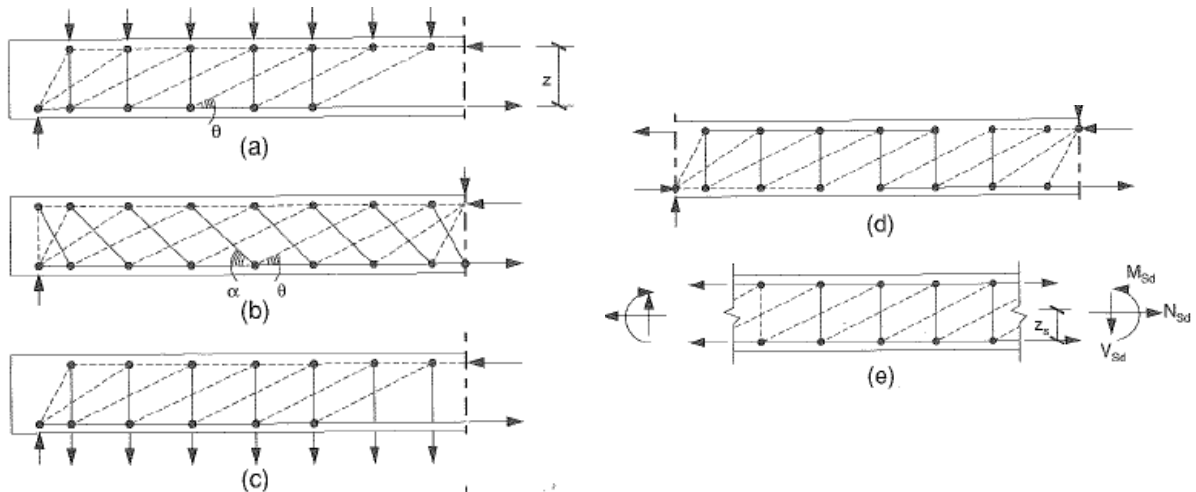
Modelos para vigas de hormigón armado con cordones paralelos:
